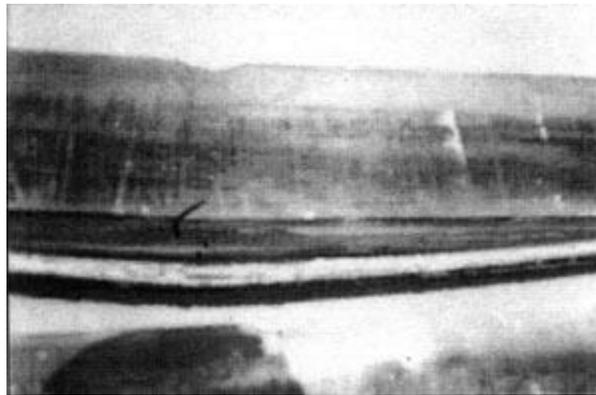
Detalle, falla al corte horizontal de resina epóxica del refuerzo metálico de la madera
